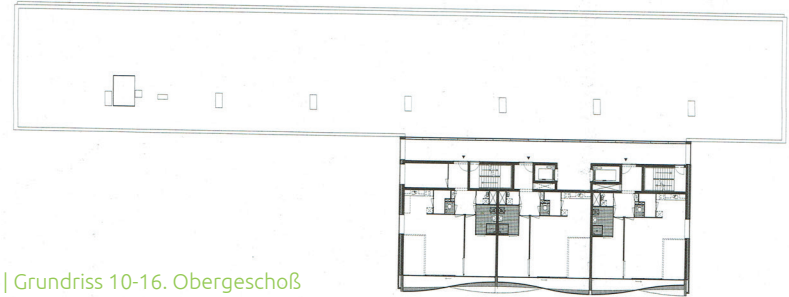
| Grundriss 10-16. Obergeschoß
